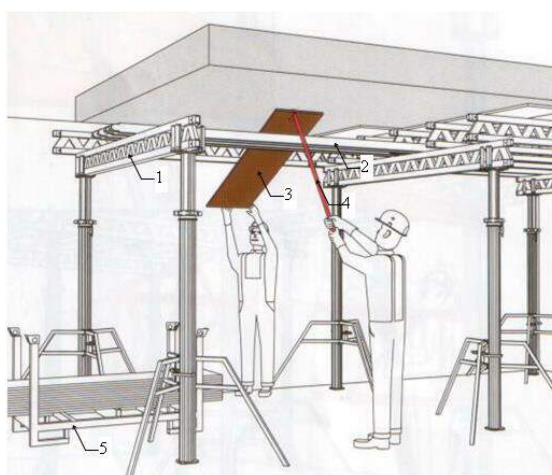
Демонтаж фанеры: 1 – продольная балка; 2 – поперечная балка скантованная «набок», 3 – демонтируемый лист фанеры; 4 – монтажная штанга; 5 – контейнер для складирования фанеры
